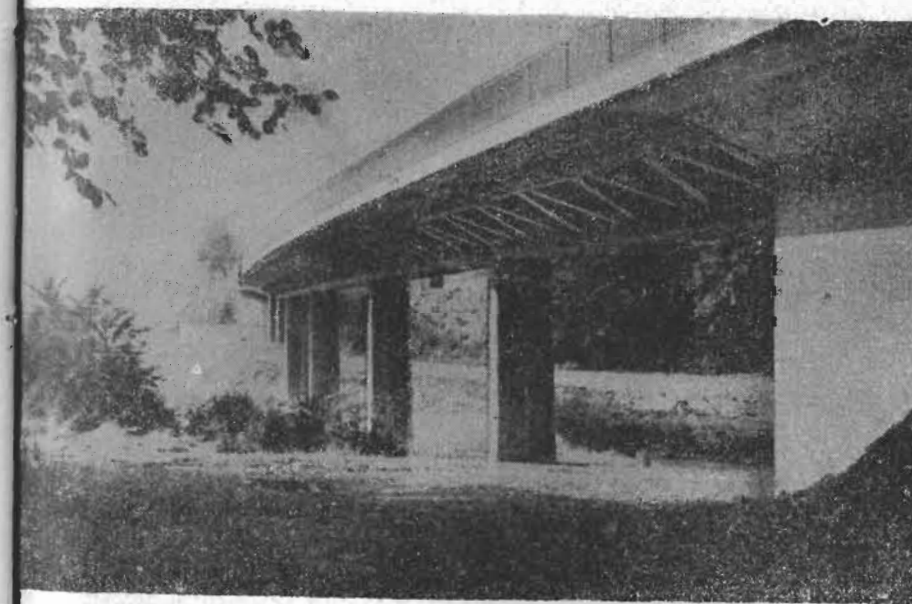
Vista del puente sobre el valle Ill en la ruta federal 27.
